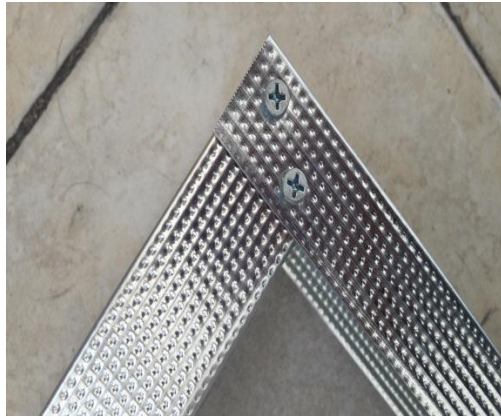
Fijación del paral base 6 y el canal base 6 por medio de un tornillo autovellanante. Fuente: Elaboración propia (2016)
